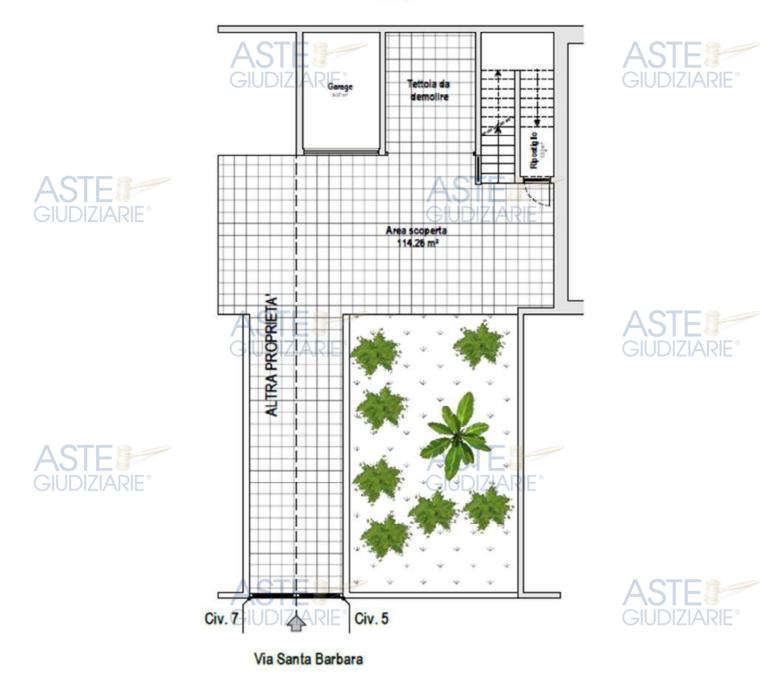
Piano Terra comprendente il cortile, il garage e la tettoia (da demolire) tutto di pertinenza dell'unità
